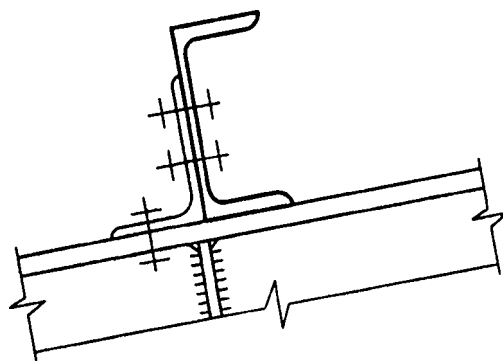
Крепление прогона к конструкции покрытия с помощью коротыша из уголка
